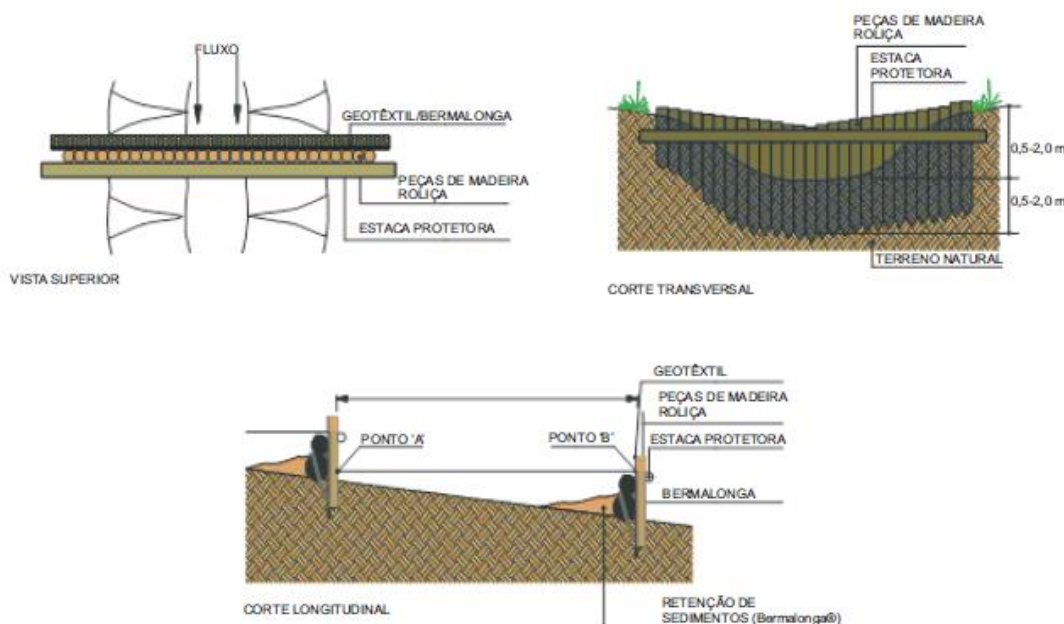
Visada em planta e corte da construção de paliçadas de madeira
